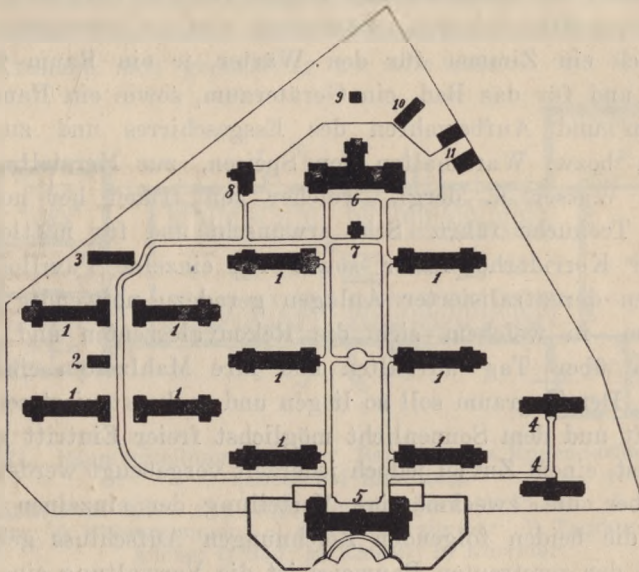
Lageplan des Krankenhauses Friedrichshain.
